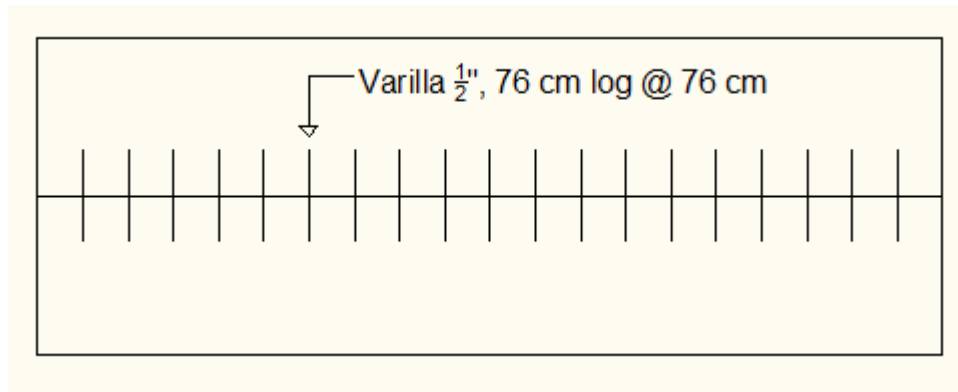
Juntas longitudinales para diseño de pavimento rígido.
